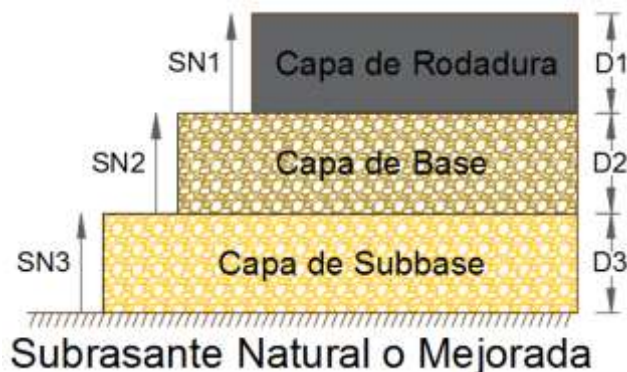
Esquema de parámetros considerados para la ecuación del número estructural (SN).
